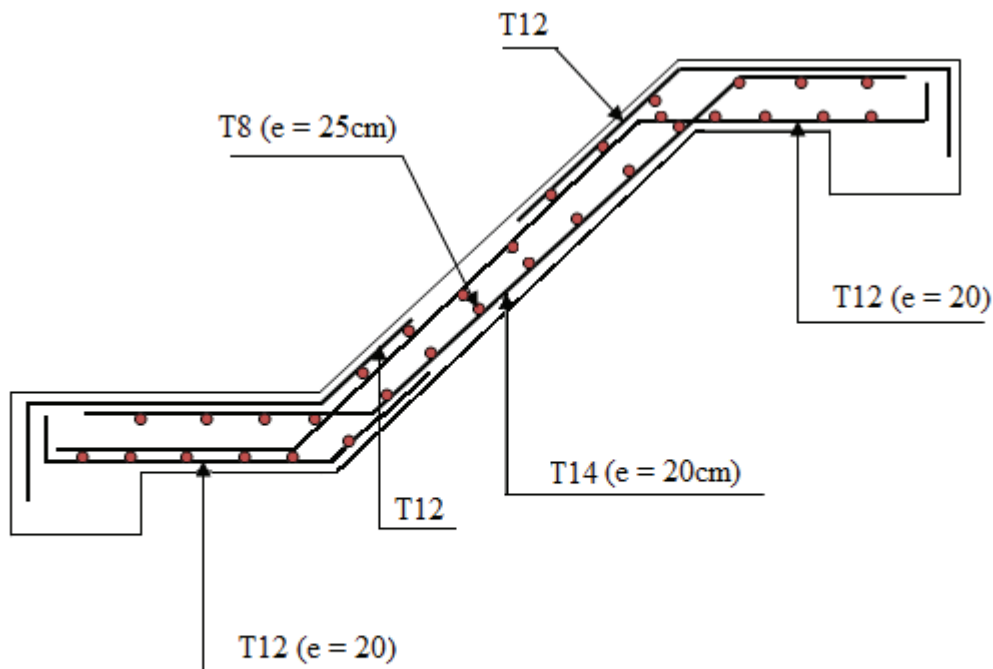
Schéma de ferrailage de l'escalier type 1
